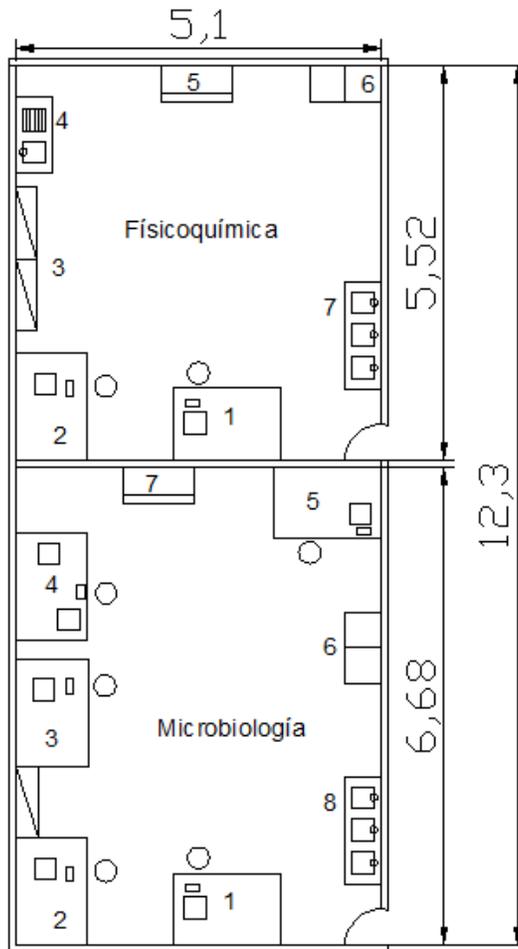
Lay-out del laboratorio. Fuente: Elaboración propia
